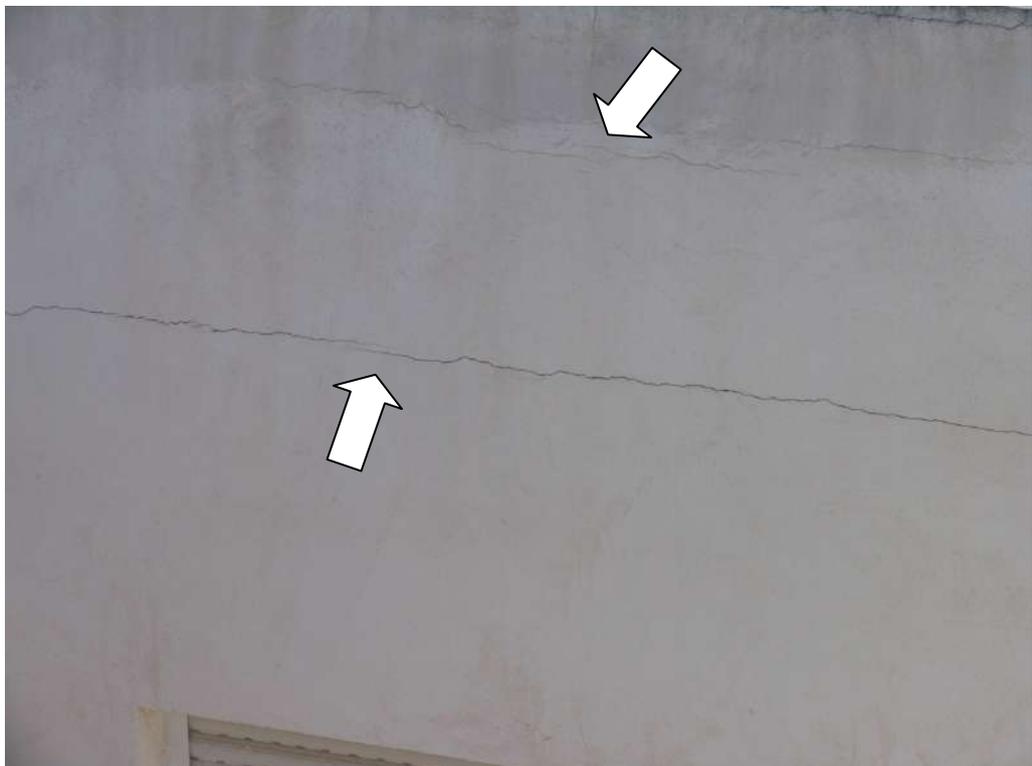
Otro detalle de las fisuras horizontales en el frente del forjado.
